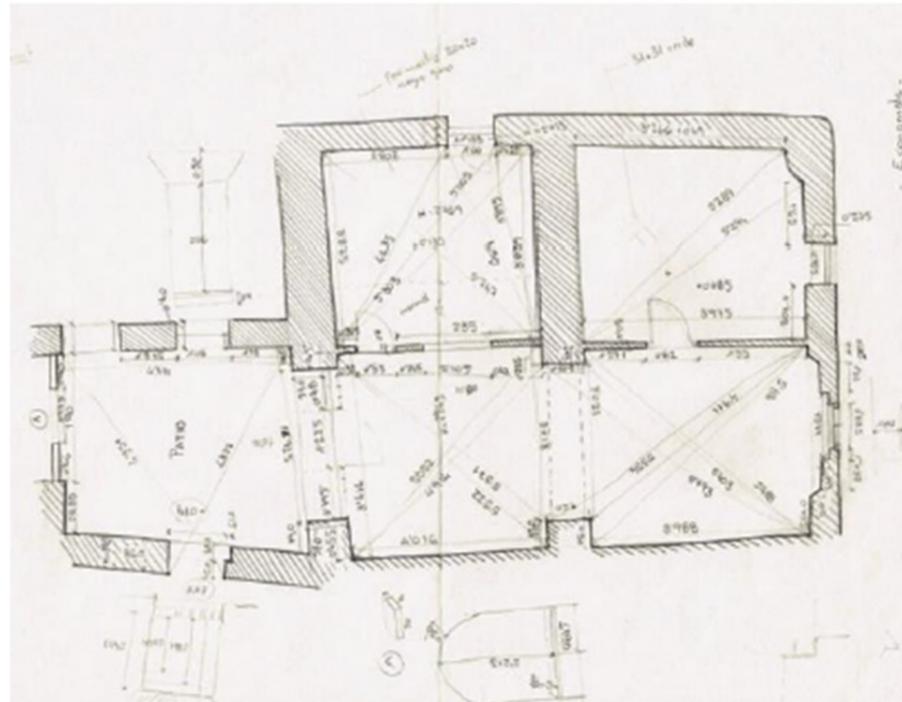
Croquis planta baja c/Puzol nº6 (Propia)
